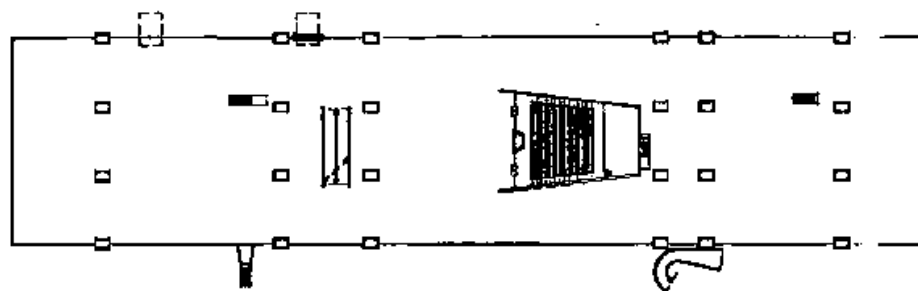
Edifício Castelo Branco – planta do pavimento térreo antes da intervenção.
